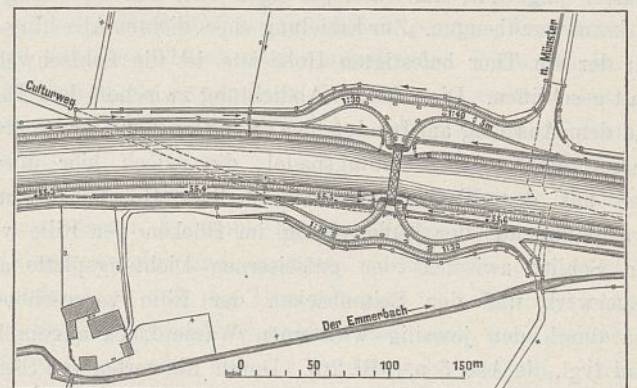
Lageplan der Ueberführung sich kreuzender Interessentenwege bei Amelsbüren Kil. 55,54.
